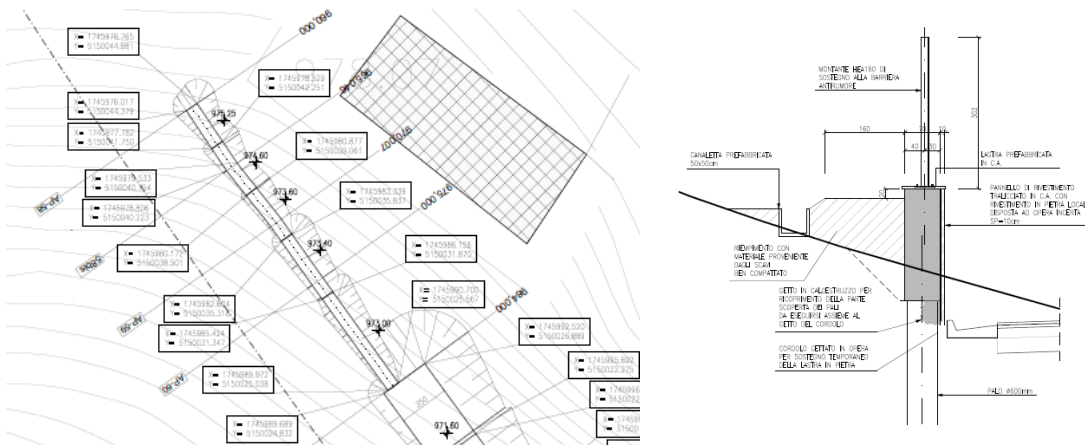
Pianta scavi e sezione del muro su pali di fronte al fabbricato della particella 308
